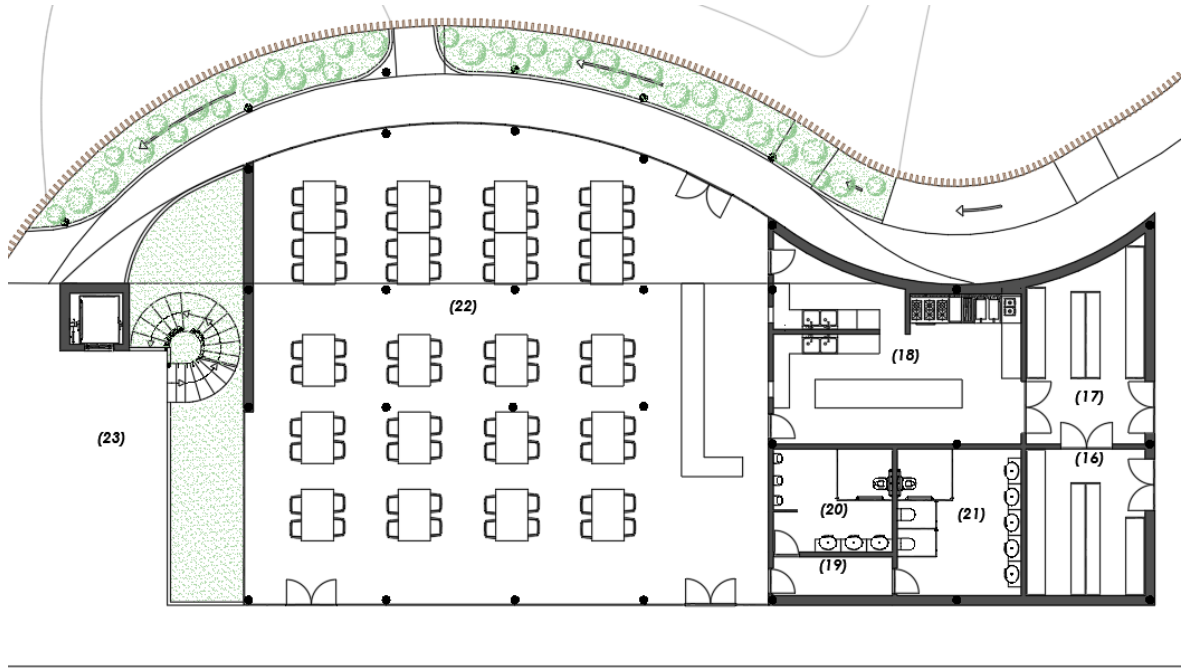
PLANTA E CORTE DO RESTAURANTE (PISO 0)
